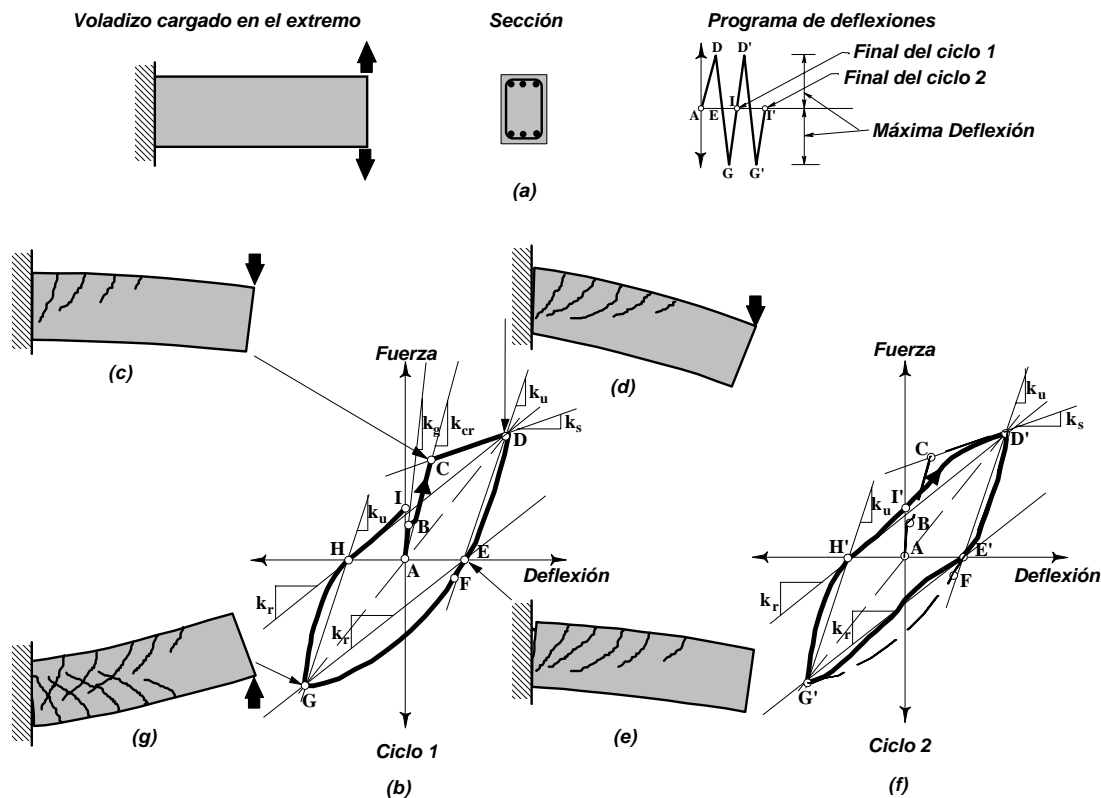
Respuesta histerética de una viga de concreto reforzado en voladizo
